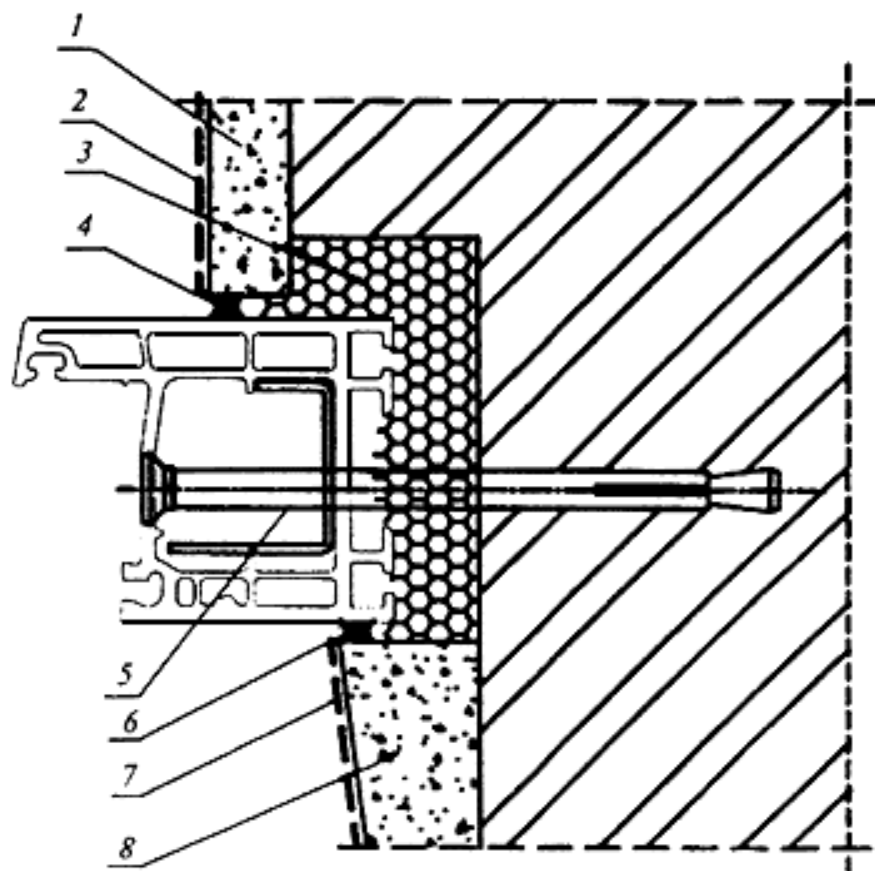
Монтажный шов узла примыкания оконного блока к стеновому проему с отделкой наружного откоса и фасада паропроницаемым штукатурным раствором:
